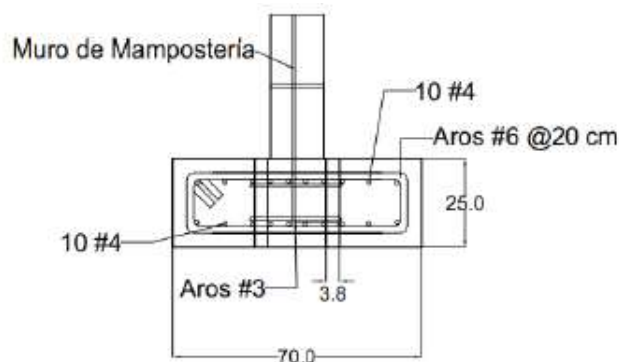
Detalle de sección transversal de la cimentación tipo 1.
